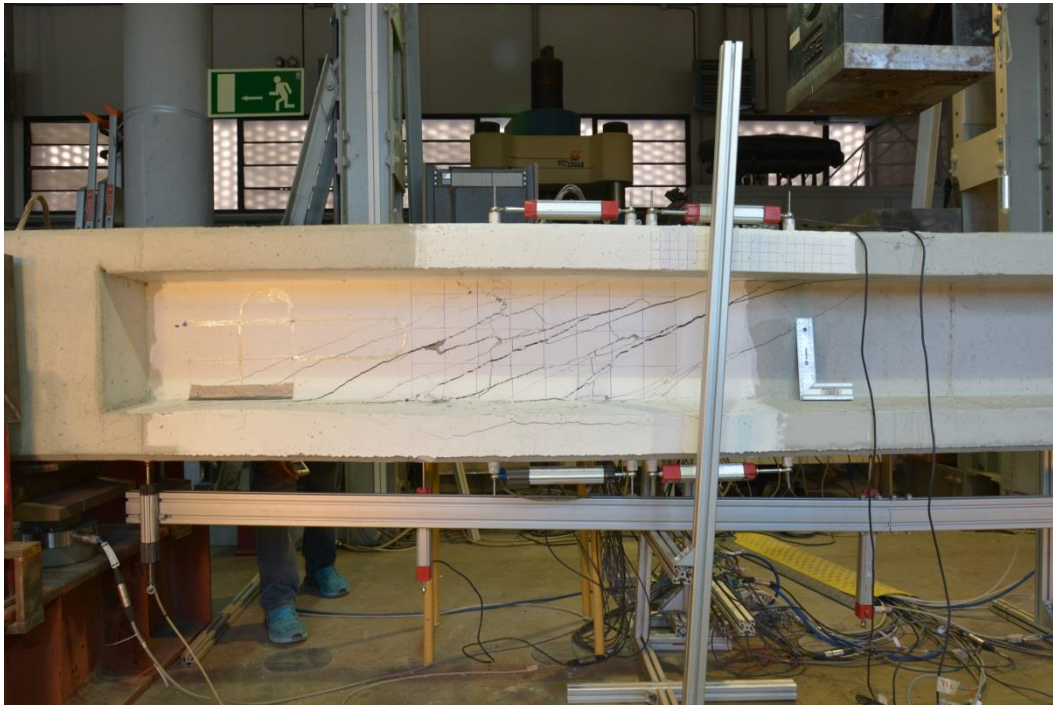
Detalle de rotura por cortante en lado tendón recto, viga I122R.
